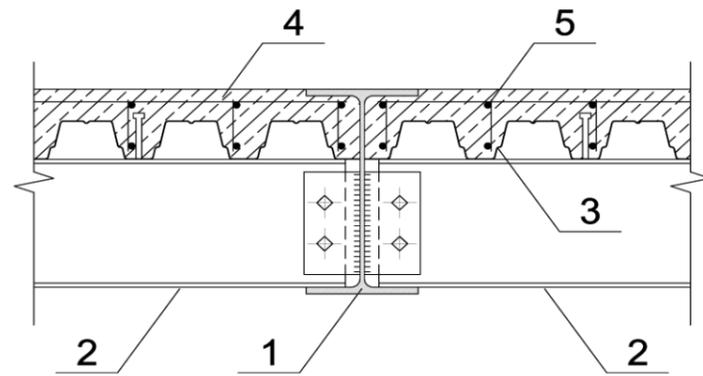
Монолитное железобетонного перекрытие по второстепенным балкам: 1- главная балка, 2 - второстепенная балка, 3 - профилированный настил, 4 - бетон перекрытия, 5 - арматурные каркасы
